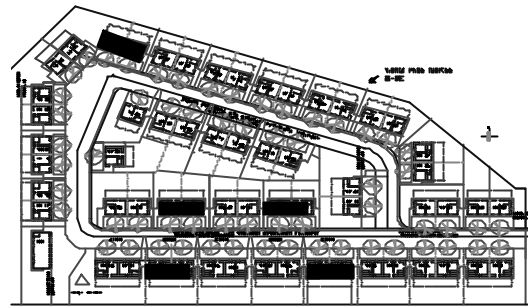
Conjunto Barrio Talca; ubicación de viviendas seleccionadas.
